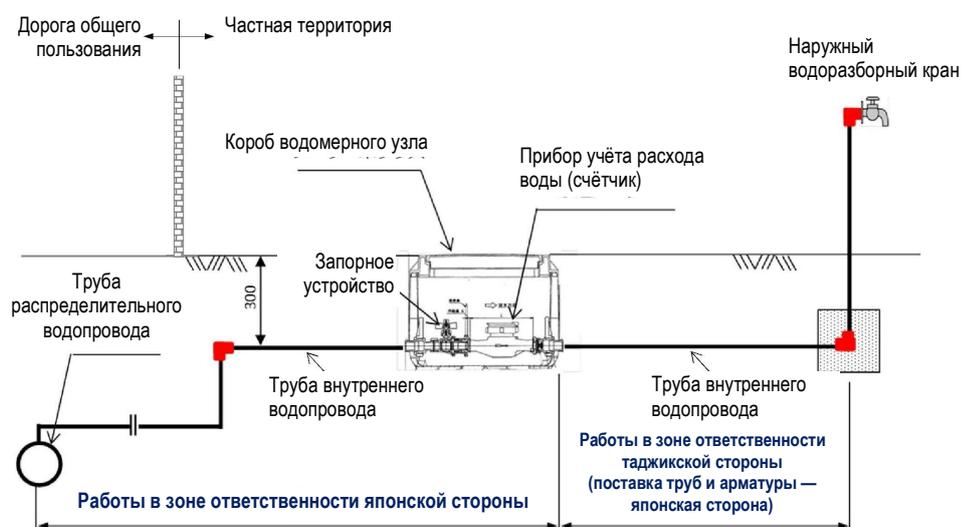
Монтаж внутренних систем водопровода и разграничение зон работ
